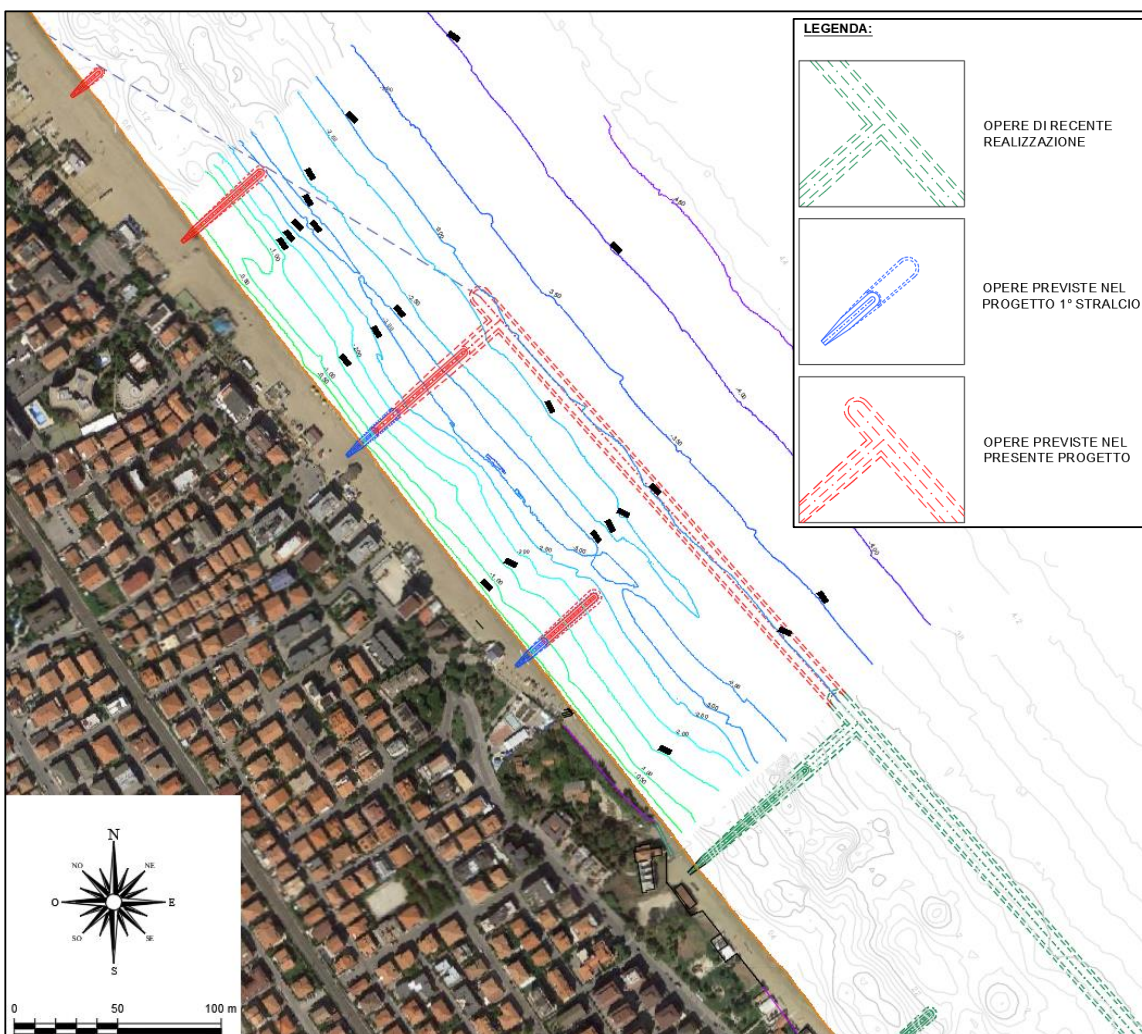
Planimetria con l'indicazione delle opere in progetto sovrapposte a quelle di recente e di prossima realizzazione.
